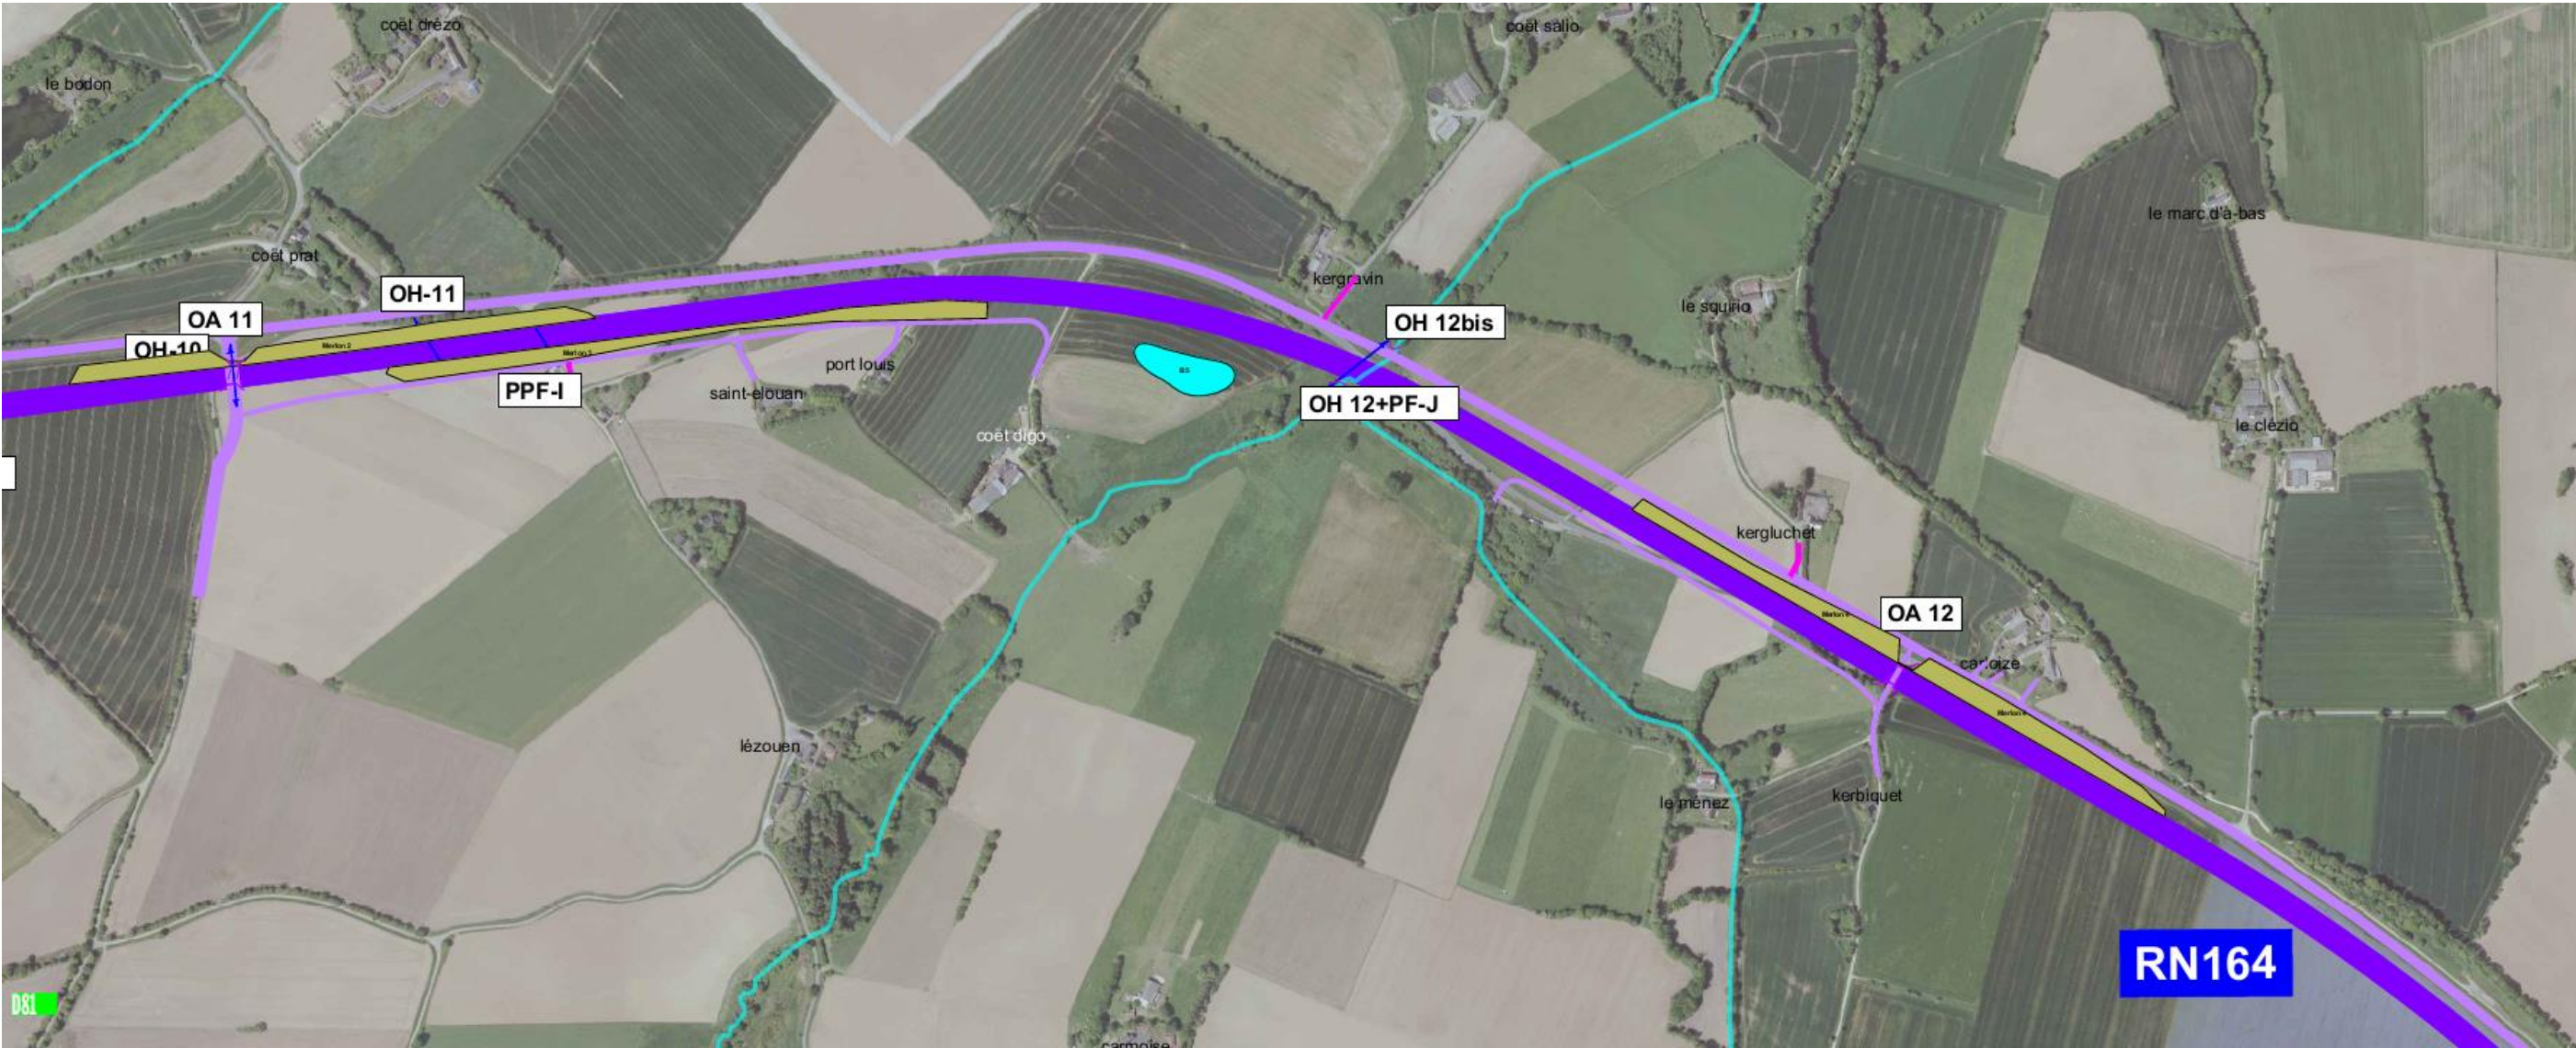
Plan général de travaux – Planche 4 (source : SIR)
